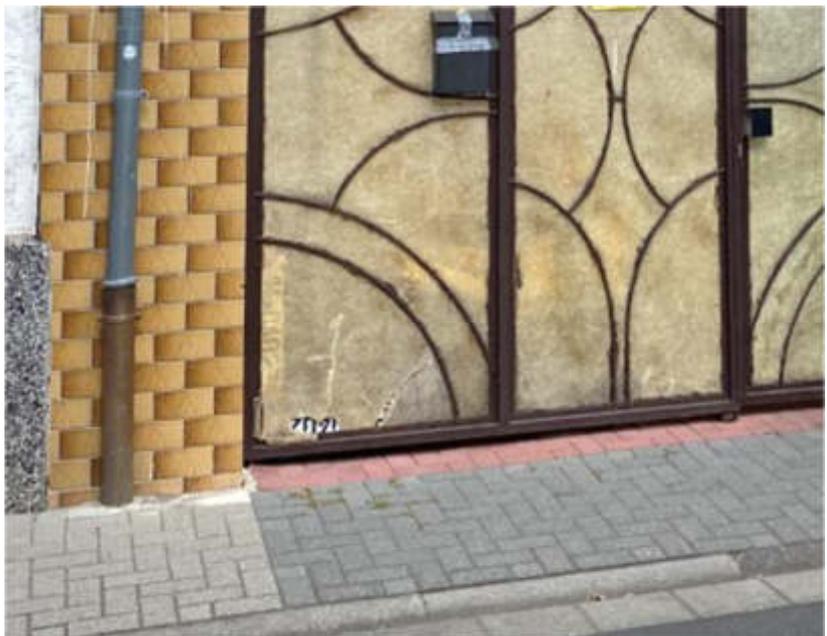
Foto des SV; Eingangstor z. T. schadhaft
